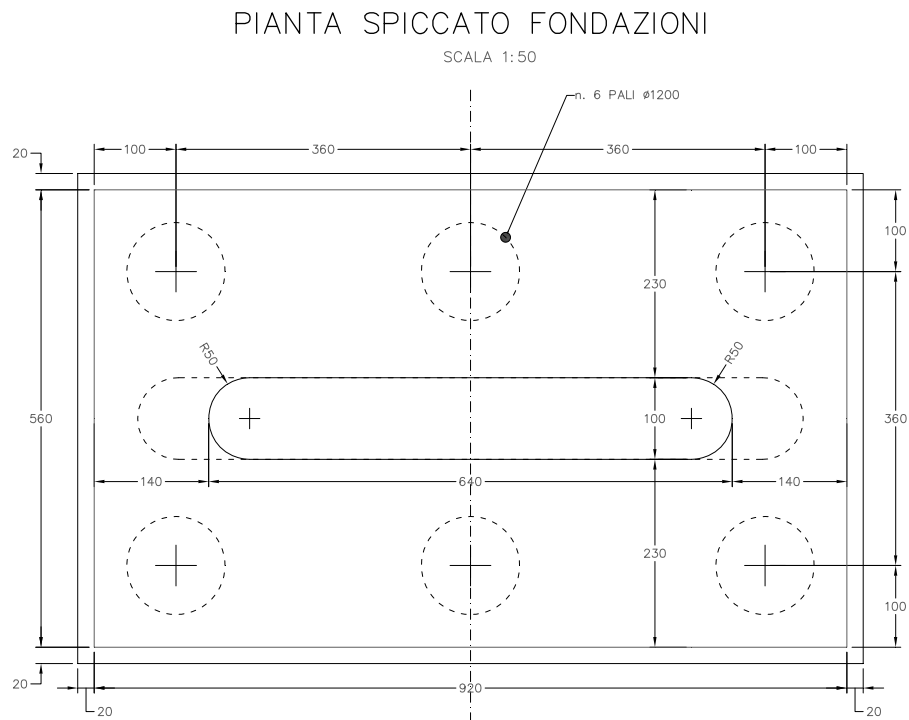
Pianta spiccatto fondazioni della Pila.
